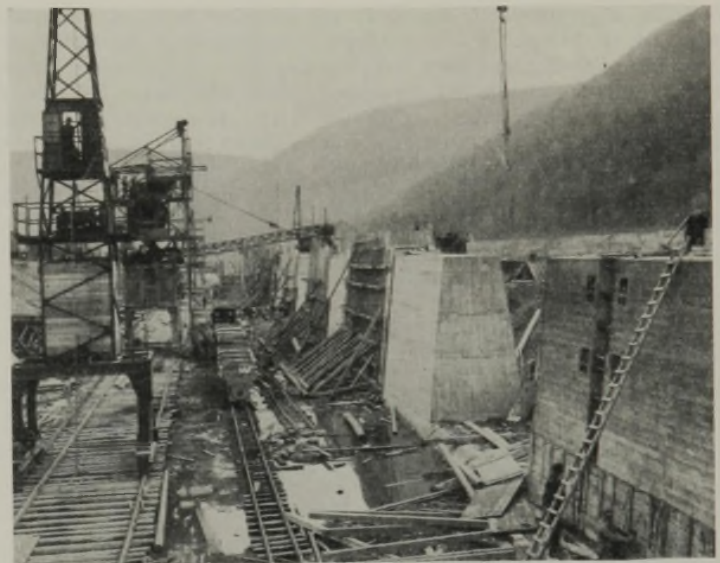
Staufufe Faulbach. Betonieren der Unterkanal-Trennmauer mit Ibag-Anlage.
